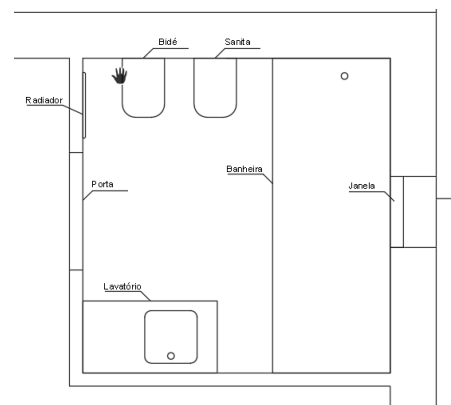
Desenho técnico do novo layout da casa de banho. Fonte: Autora
